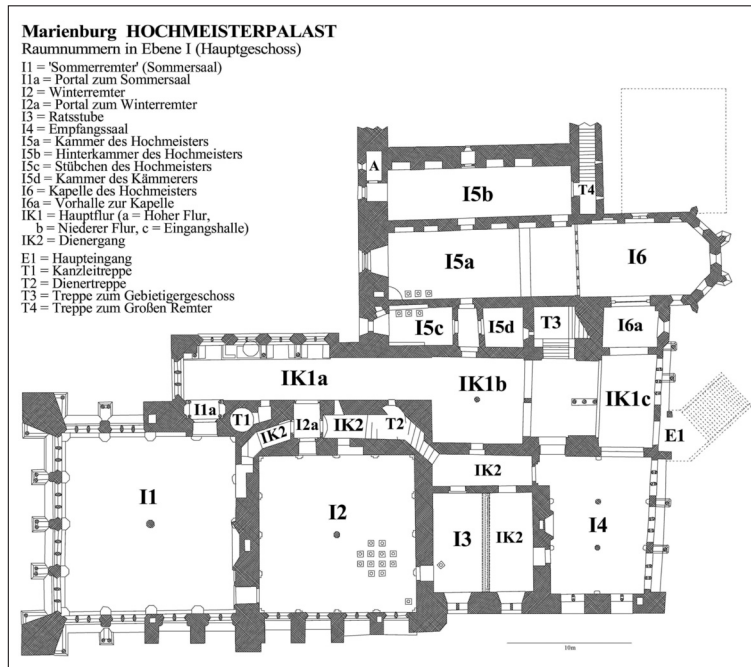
Grundriss von Ebene I (Hochmeistergeschoss) mit Angabe der Raumnutzung
